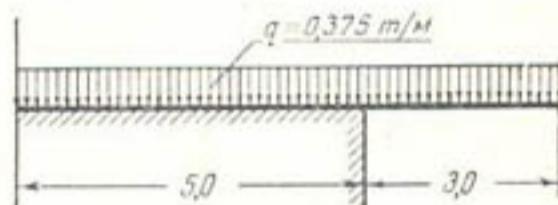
Расчетная схема лотка на монтажную нагрузку (2-й случай).
